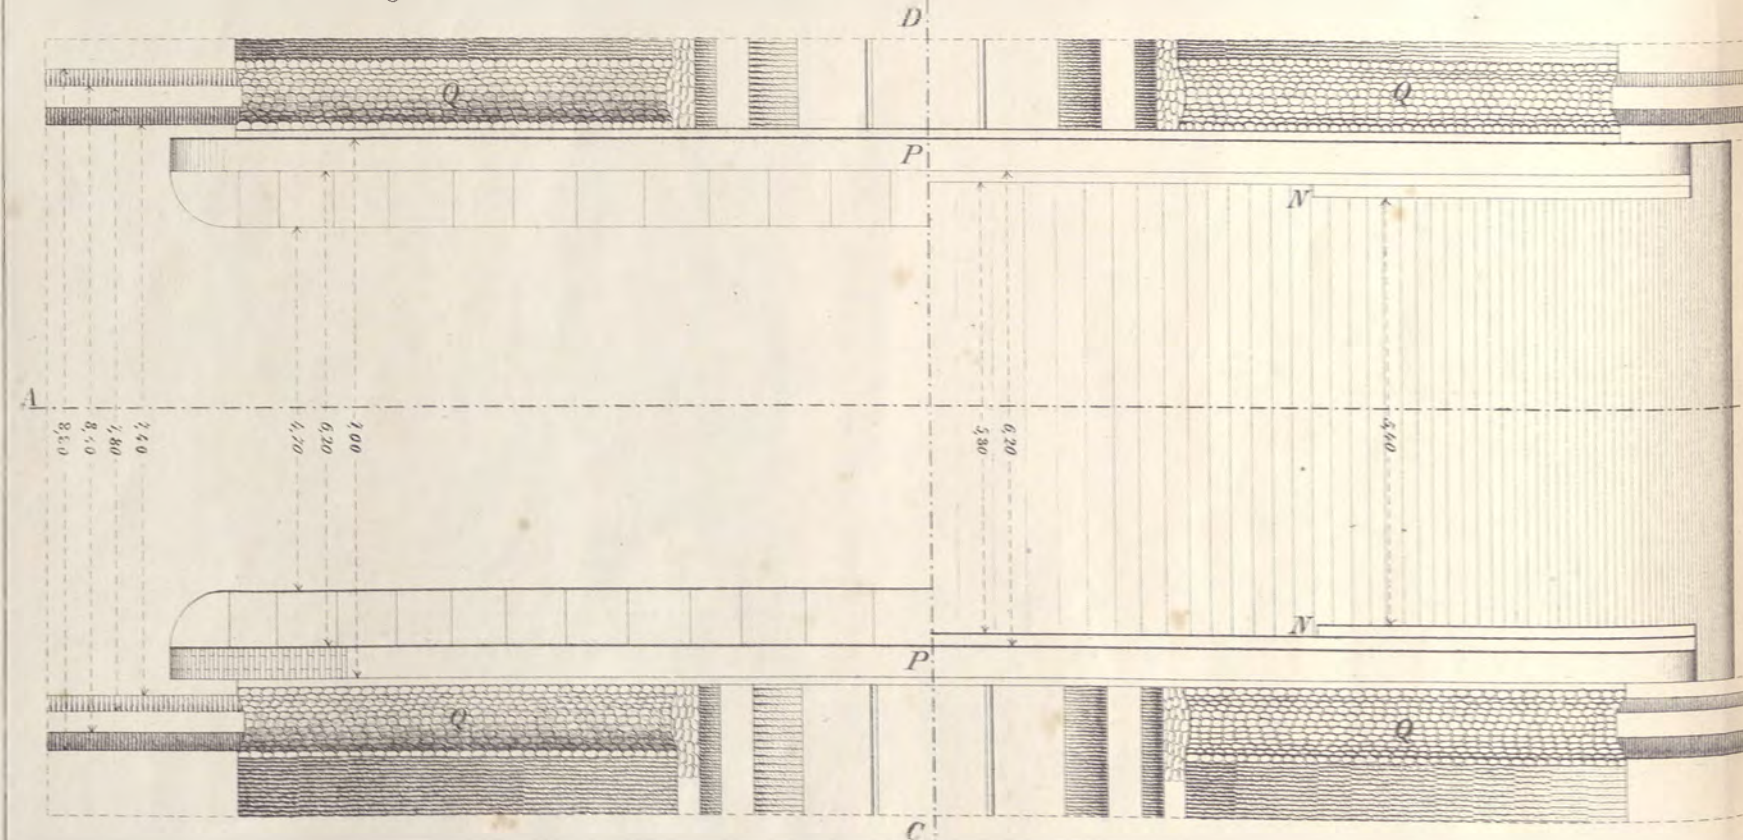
<sup>a</sup> Pianta ad opera finita e proiezione orizzontale supposto tolto il terreno.
